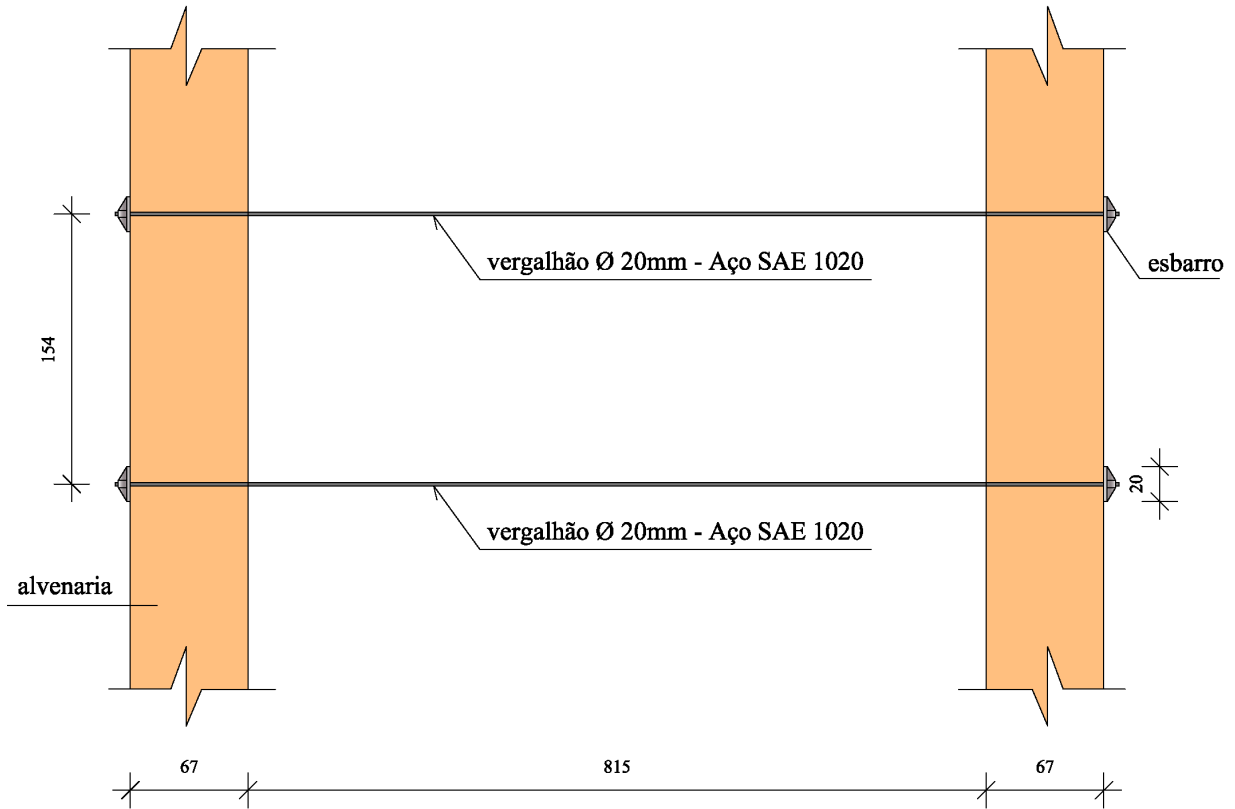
Sistema de estabilização proposto para a alvenaria, em planta (sem escala).
